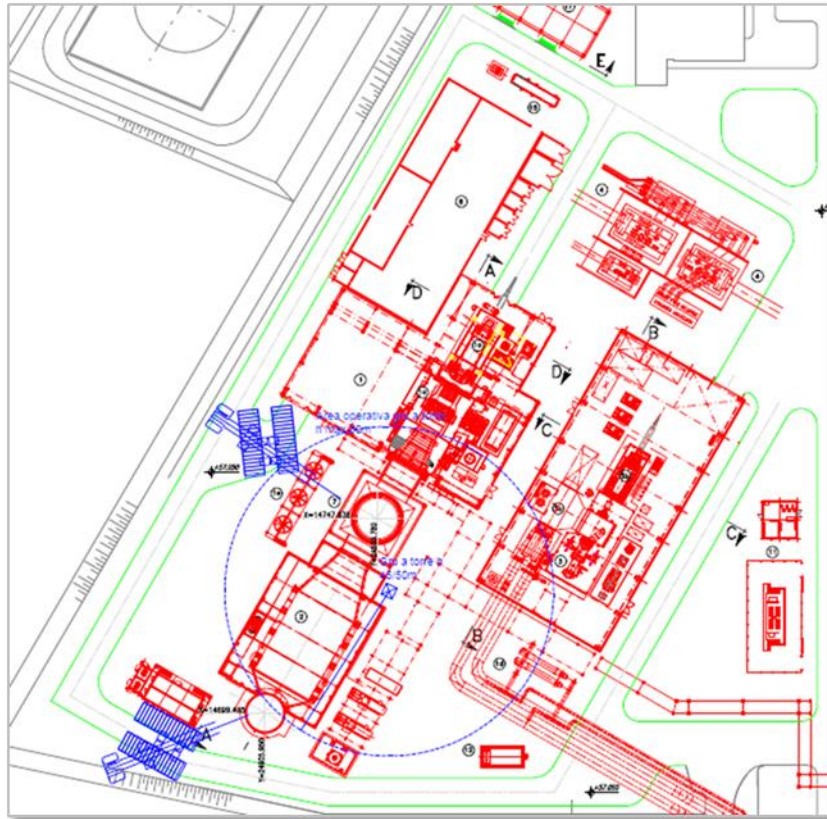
Disposizione tipo mezzi di sollevamento
